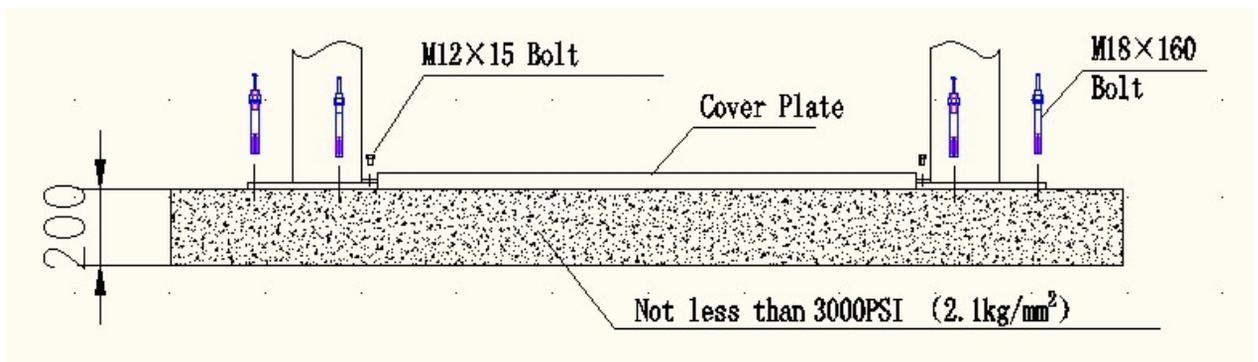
ПЛАН ФУНДАМЕНТА
